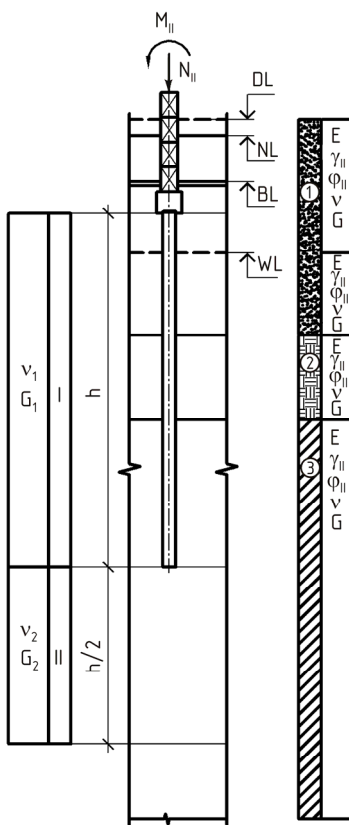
Схема к расчету свайного фундамента по деформациям (при низком ростверке)
